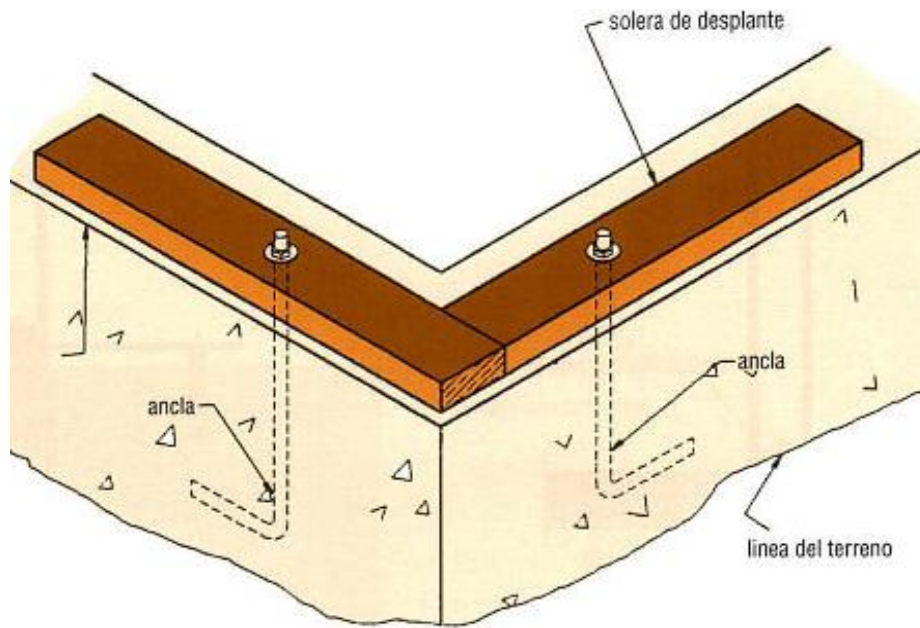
a) Anclaje de Soleras a la Cimentación.
